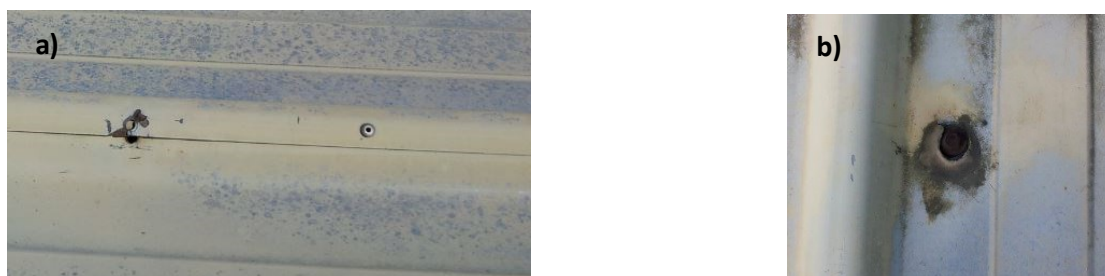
a) pormenor de rebite danificado [4] ; b) pormenor de parafuso corroído [4].
